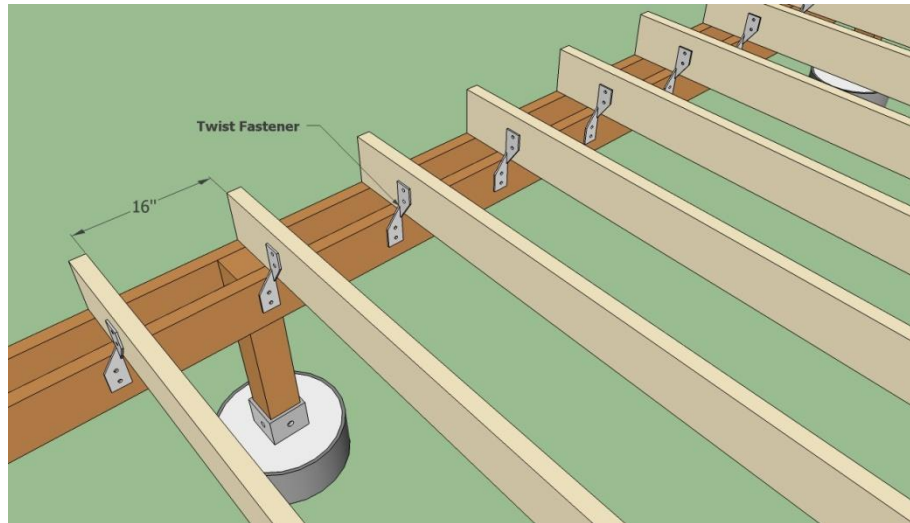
Exemplo de estrutura de suporte para deck [116]
